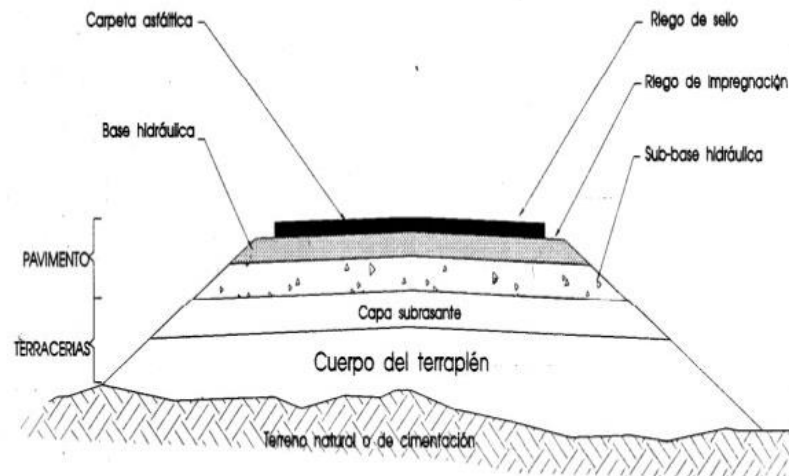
Componentes estructurales de un pavimento flexible
